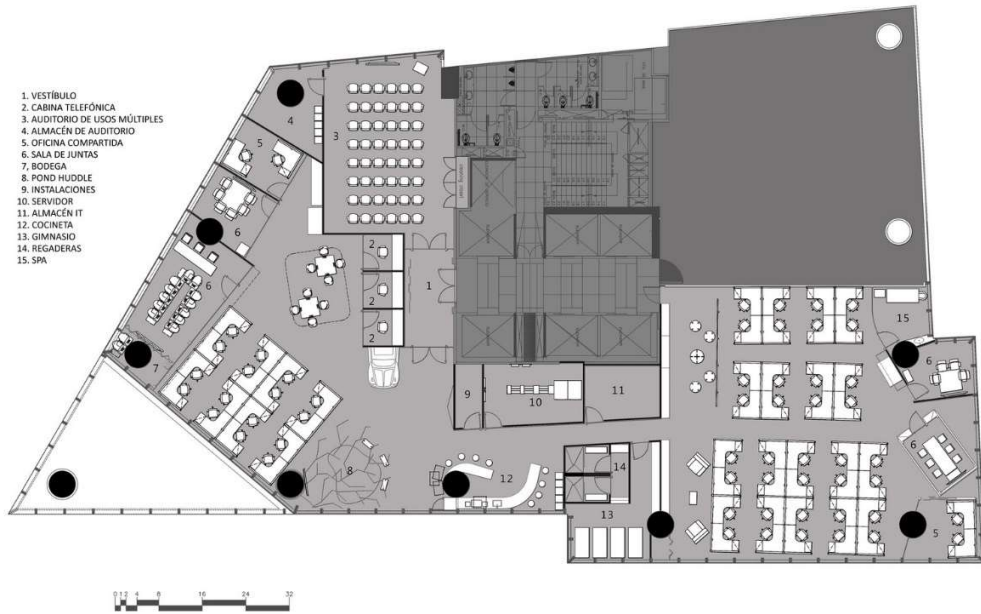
Planta 1 / Fuente: ArchDaily Google - México
